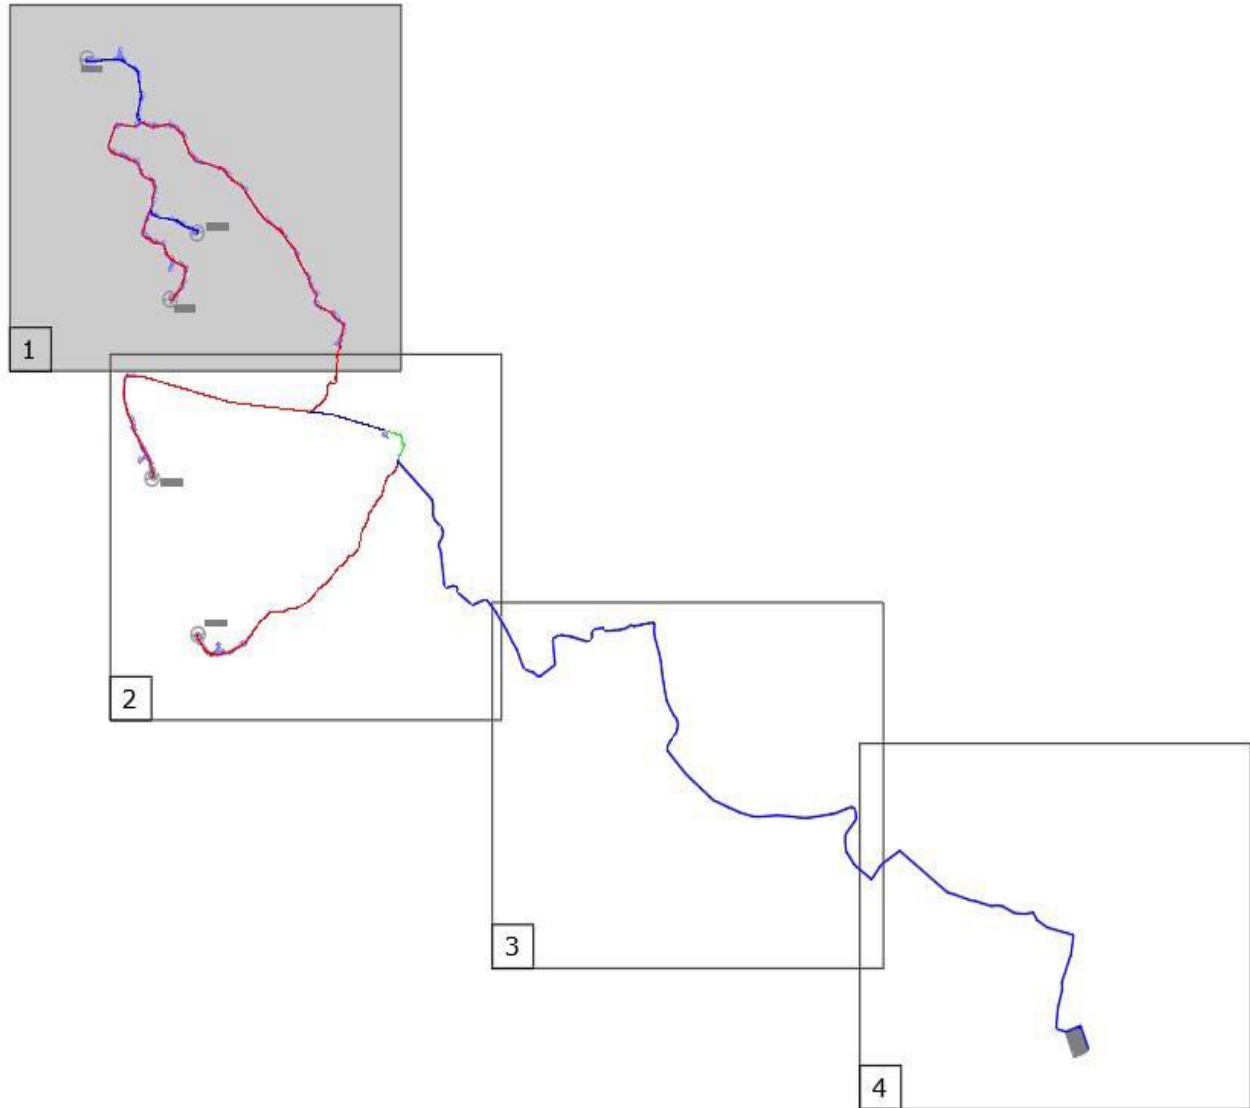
Suni (OR)_ Keyplan Progetto Cavidotti.
